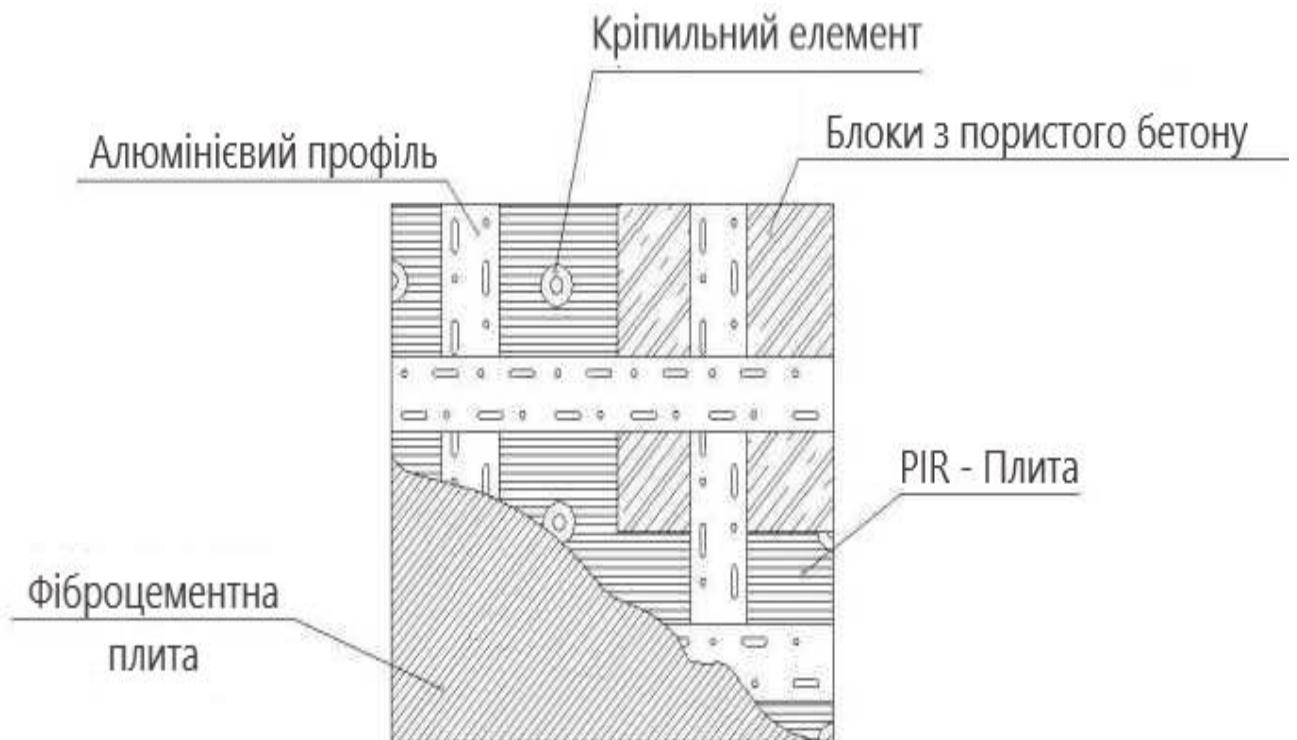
PIR - плита, як утеплювач навісного фасаду
